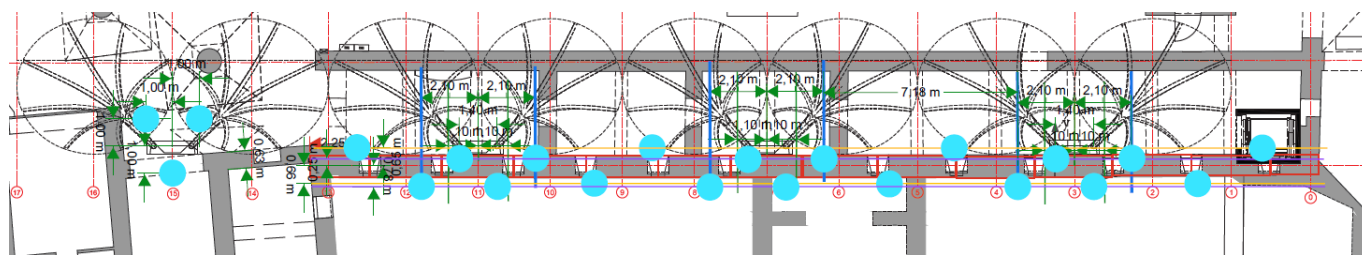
Plan de principe de l'implantation des colonnes de jet grouting au droit de la façade contemporaine
